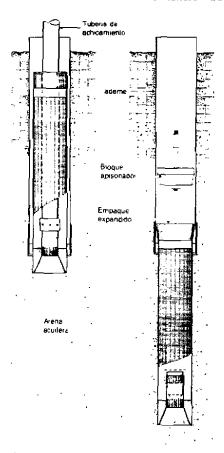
(Izquierda) Disposición de rejilla y accesorios de achicamiento, para dar comienzo a la operación, y (derecha), etapa final de la instalación de la rejilla por el método de achicamiento.
